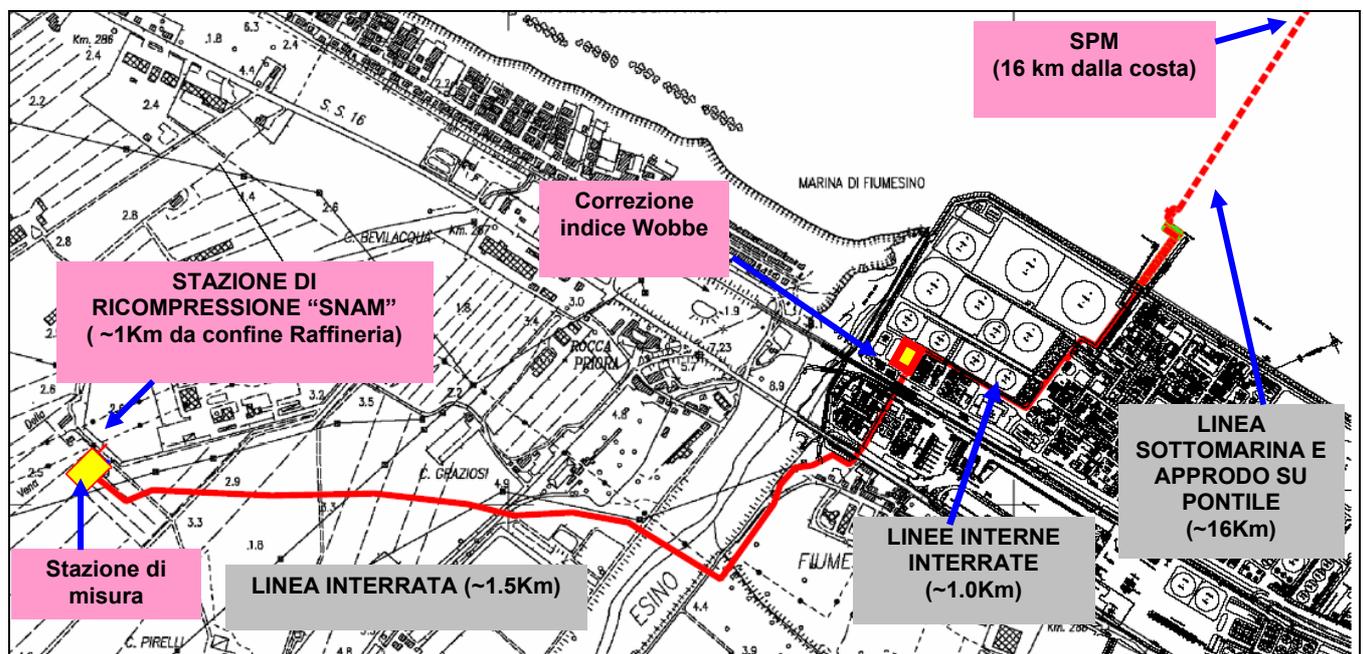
layout preliminare nuovo gasdotto di collegamento SPM-Stazione SNAM
